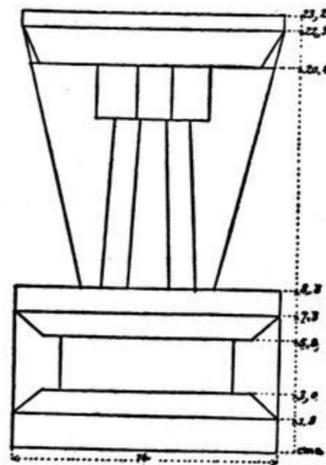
Pierre de taille d'un pilastre double (TK, 13).
